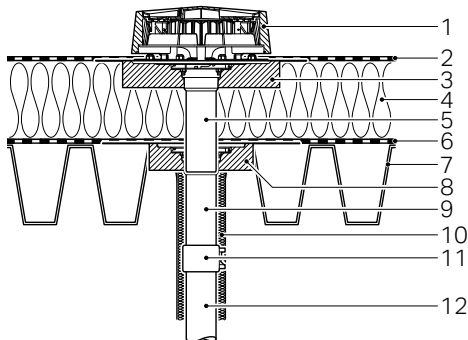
Aufbau Leichtdach gedämmt, mit Dachabdichtungsfolie und Dampfsperrenanschluss
